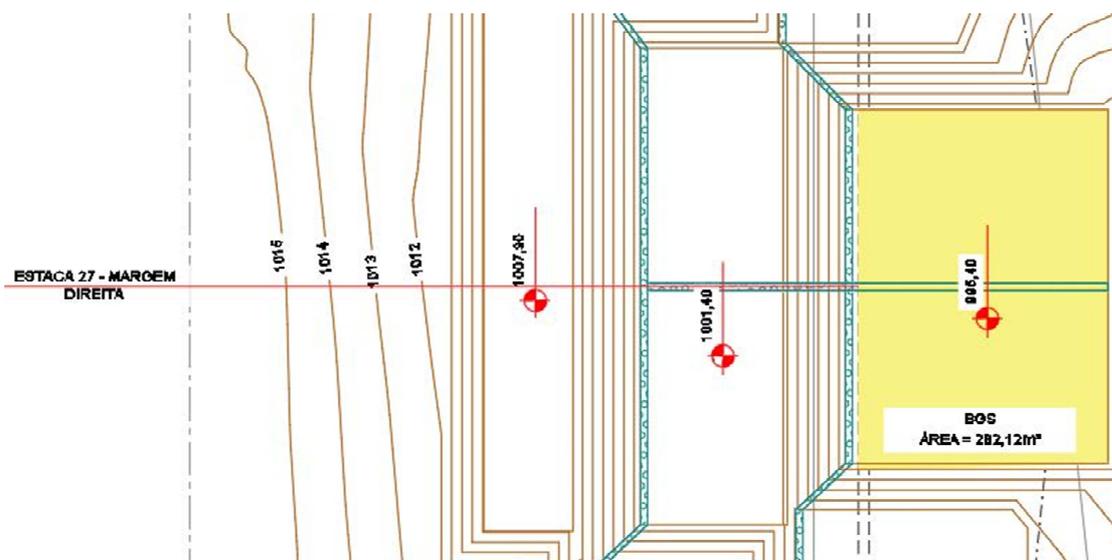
Planta da escavação para implantação do aterro reforçado, região com utilização de BGS - Estaca 27
